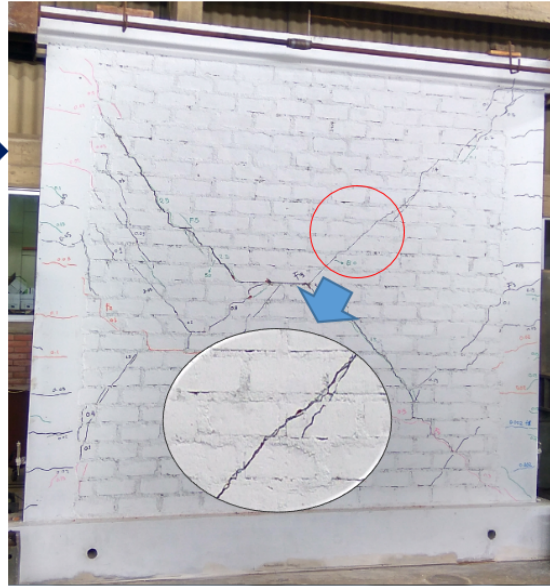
Patrón de fisuras de muretes en muro confinado.
